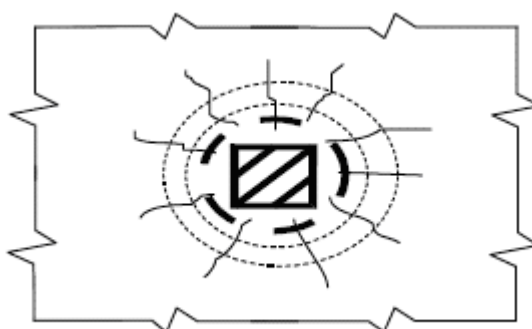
Fissuras ou rupturas por punção, fonte DNER 1994:
